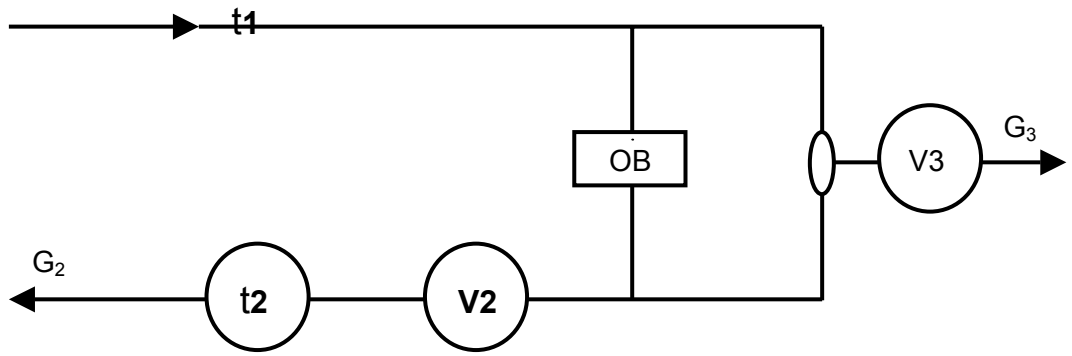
Открытая система теплоснабжения с водосчетчиком в обратном трубопроводе и трубопроводе ГВС.
